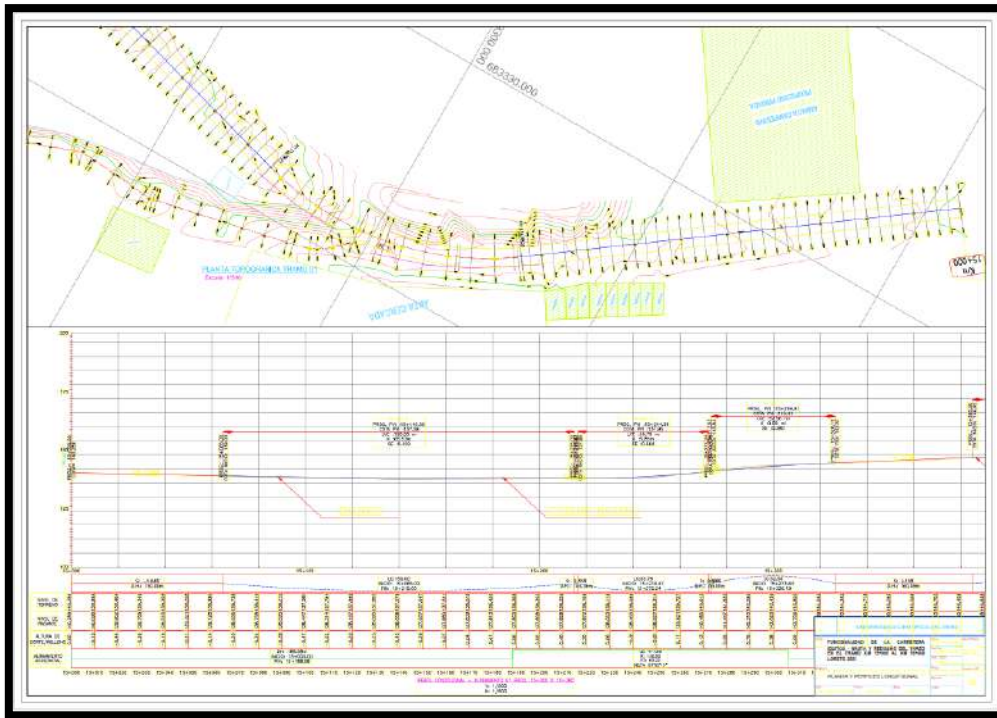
Plano de Planta y Perfil km 15+400 al km 15+800
